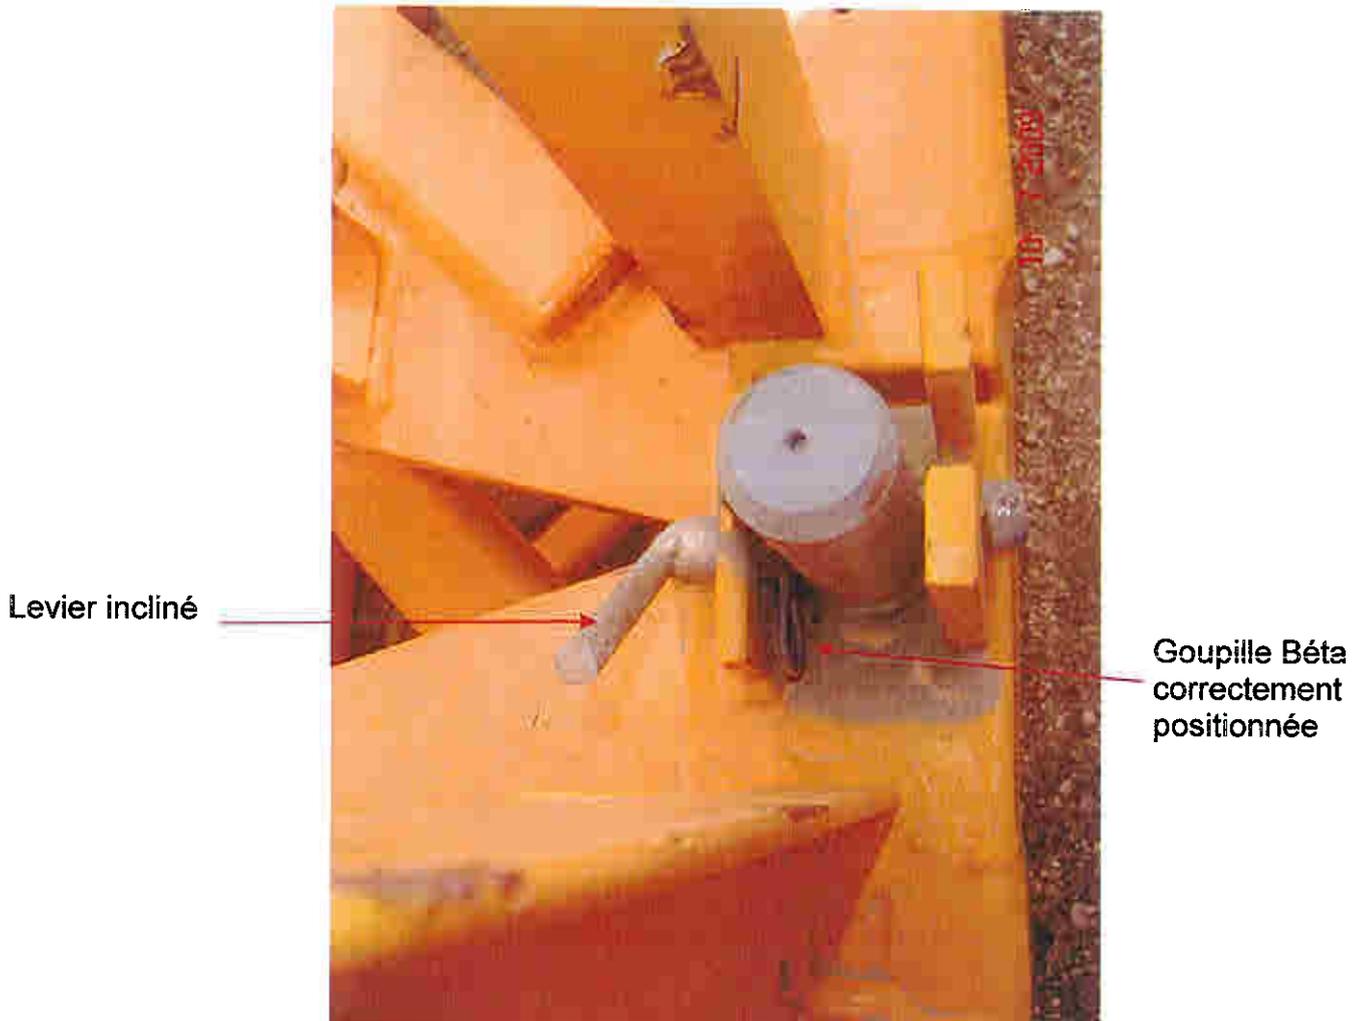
Exemple d'assemblage intact sur la grue litigieuse
